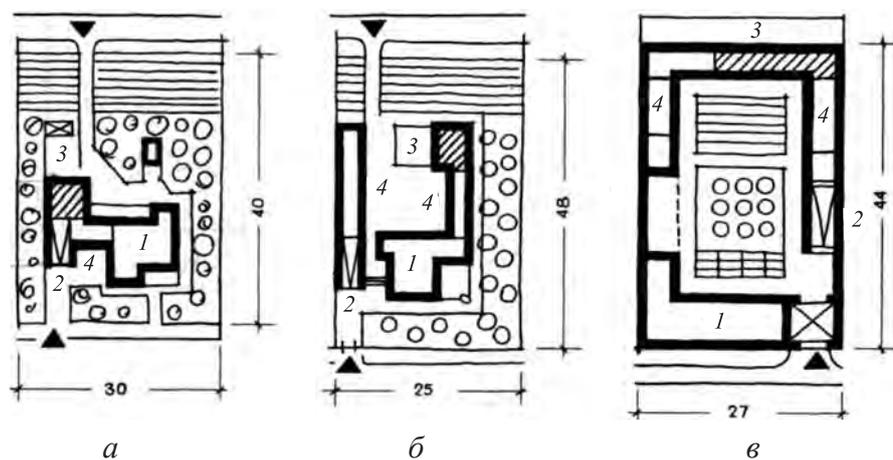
Планировка приусадебного участка с пристроенными к жилым домам хозяйственными помещениями: *а* — хозяйственные помещения (кроме летней кухни) сблокированы с домом; *б* — хозяйственные помещения сблокированы с домом, размещаются по периметру замкнутого двора; *в* — хозяйственные помещения размещаются по периметру участка: *1* — жилой дом; *2* — гараж; *3* — помещения для домашних или декоративных животных и птицы; *4* — хозяйственные помещения
